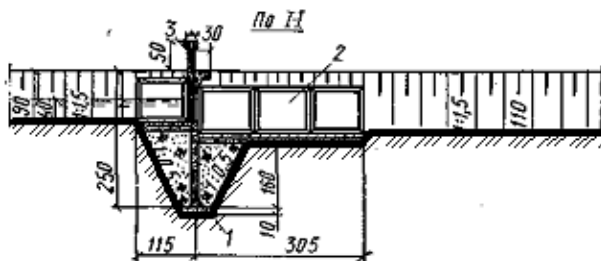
Открытый шлюз-регулятор из сборного железобетона:
